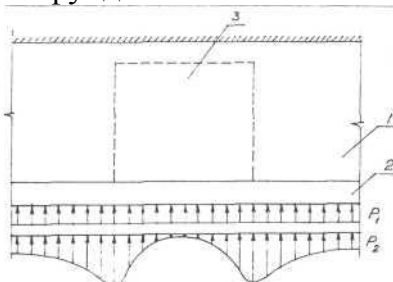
(1 — стена подвала, 2 — проём, 3 — ленточный фундамент, p_1 — реактивное давление грунта до устройства проёма, p_2 — то же, после устройства)
